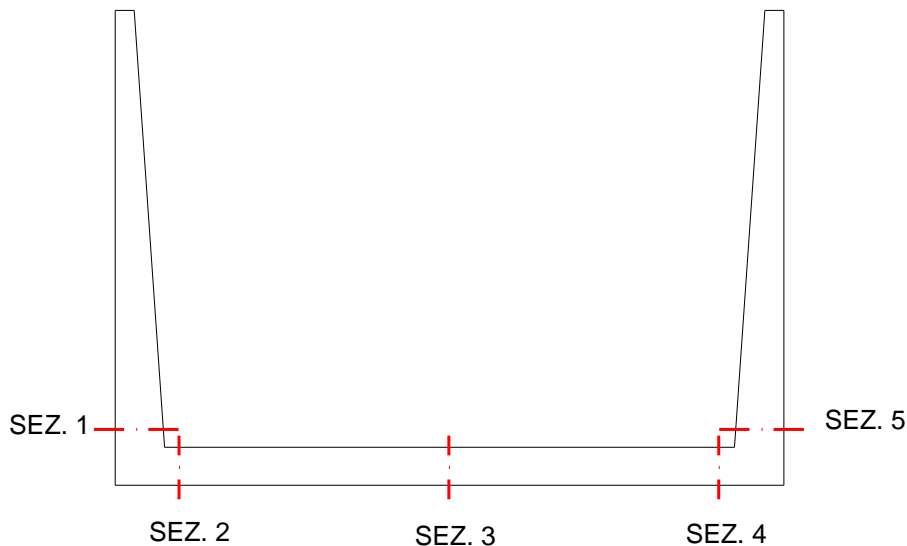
Schema sezione trasversale del muro e sezioni di verifica.
